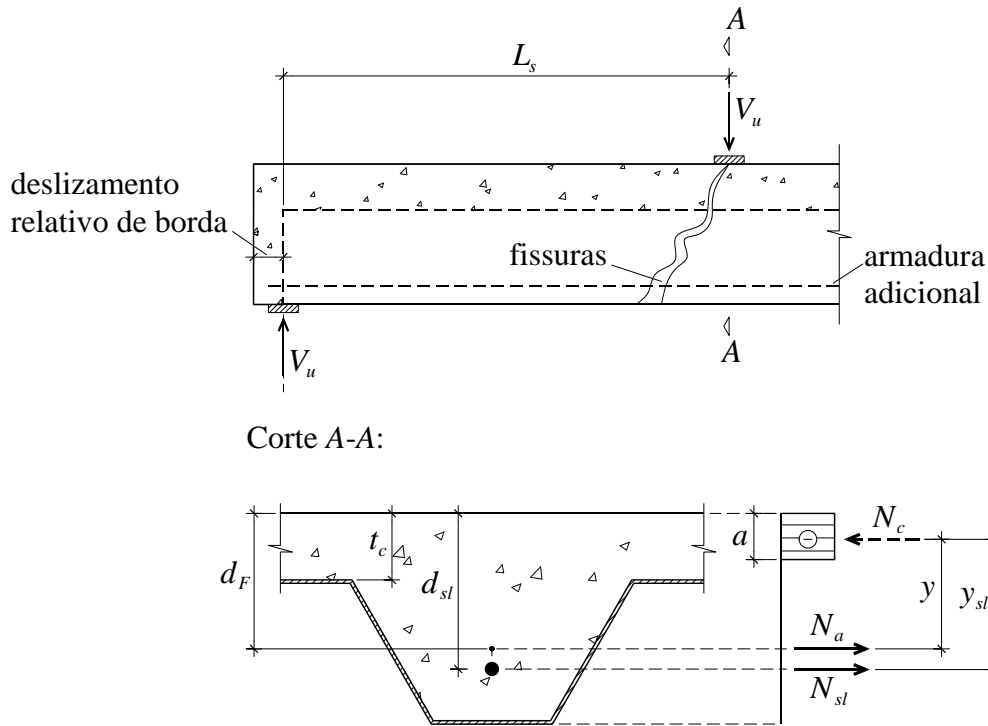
Mecanismo de falha para cisalhamento longitudinal e respectivas distribuições de tensões e forças internas consideradas para lajes mistas com armadura adicional com linha neutra no bloco de concreto em interação parcial acima da face superior da fôrma de aço.
